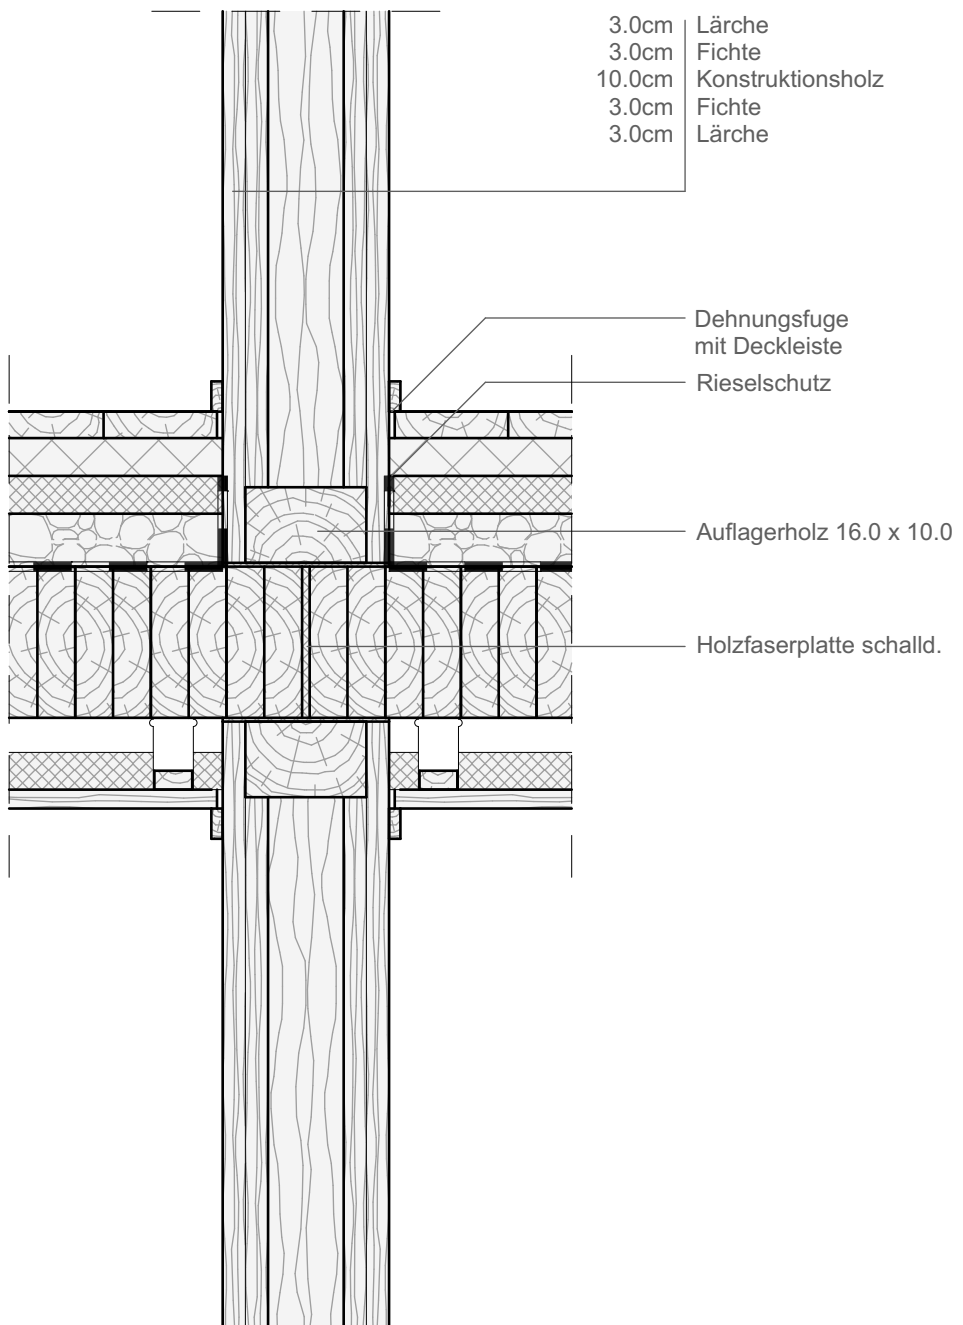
tragende Innenwand - Detail M 1:10
